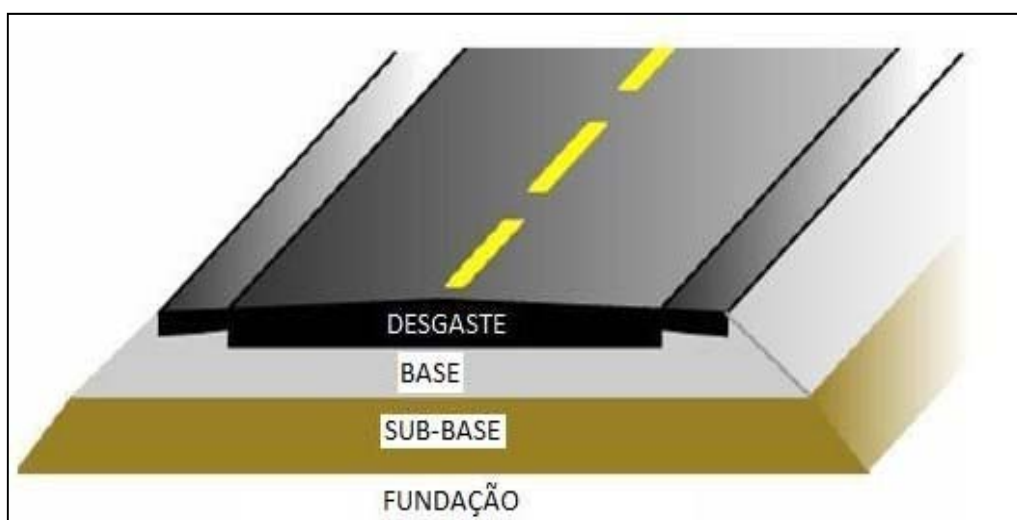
Estrutura Constituinte de um pavimento rodoviário adaptado de (Specht, 2005)
